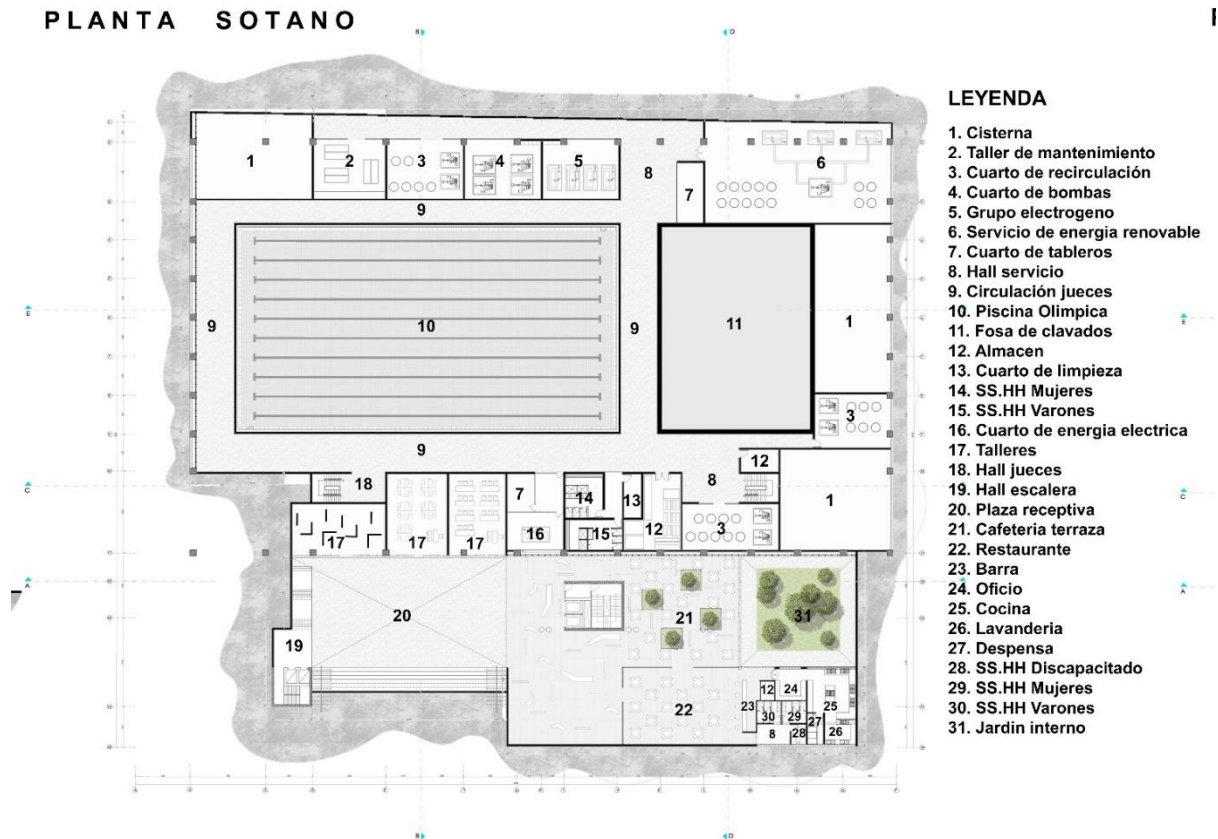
Planta Sótano Piscina Municipal. (Fuente: propia)
